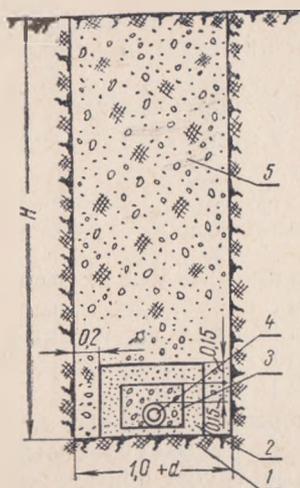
Конструкция трубчатой дрены на строительной площадке:
